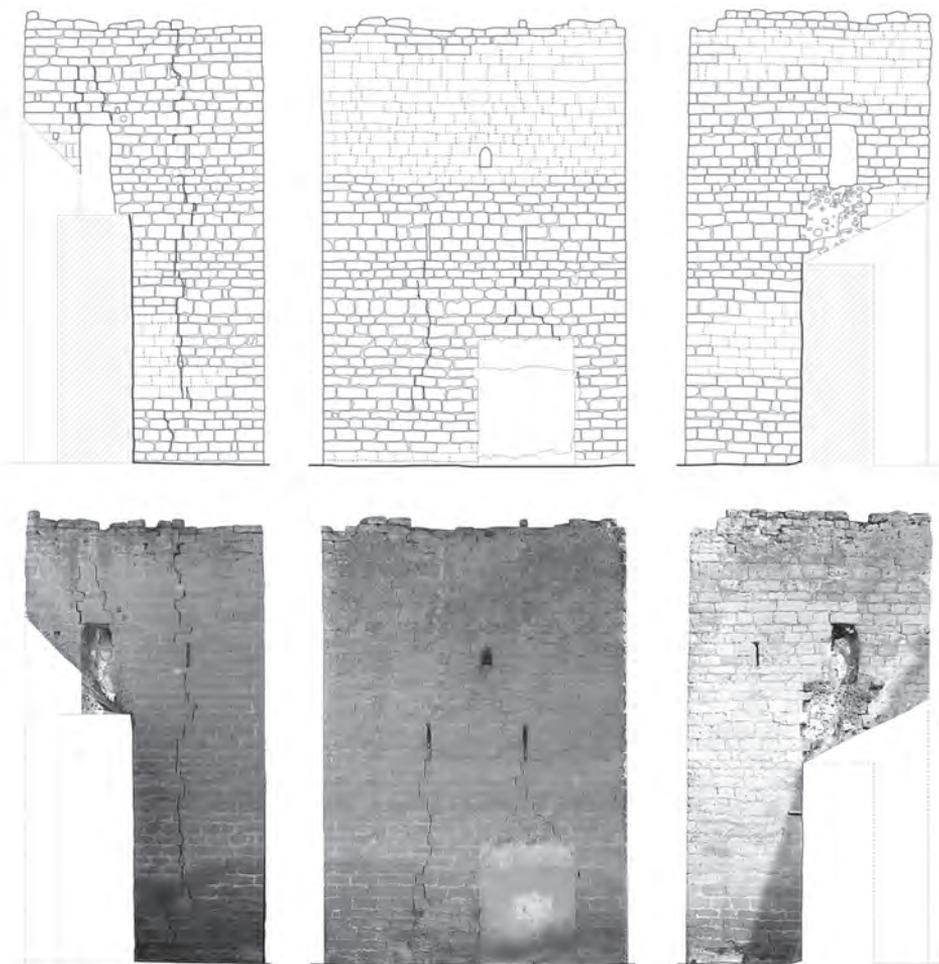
y 08. Planta, alzado y ortofoto de uno de los tramos de muralla analizados.
